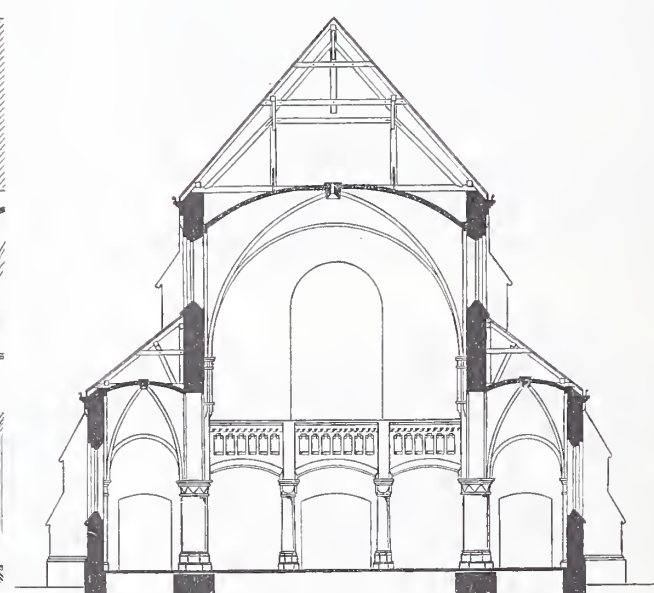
Querschnitt mit Blick gegen die Orgelbühne.
